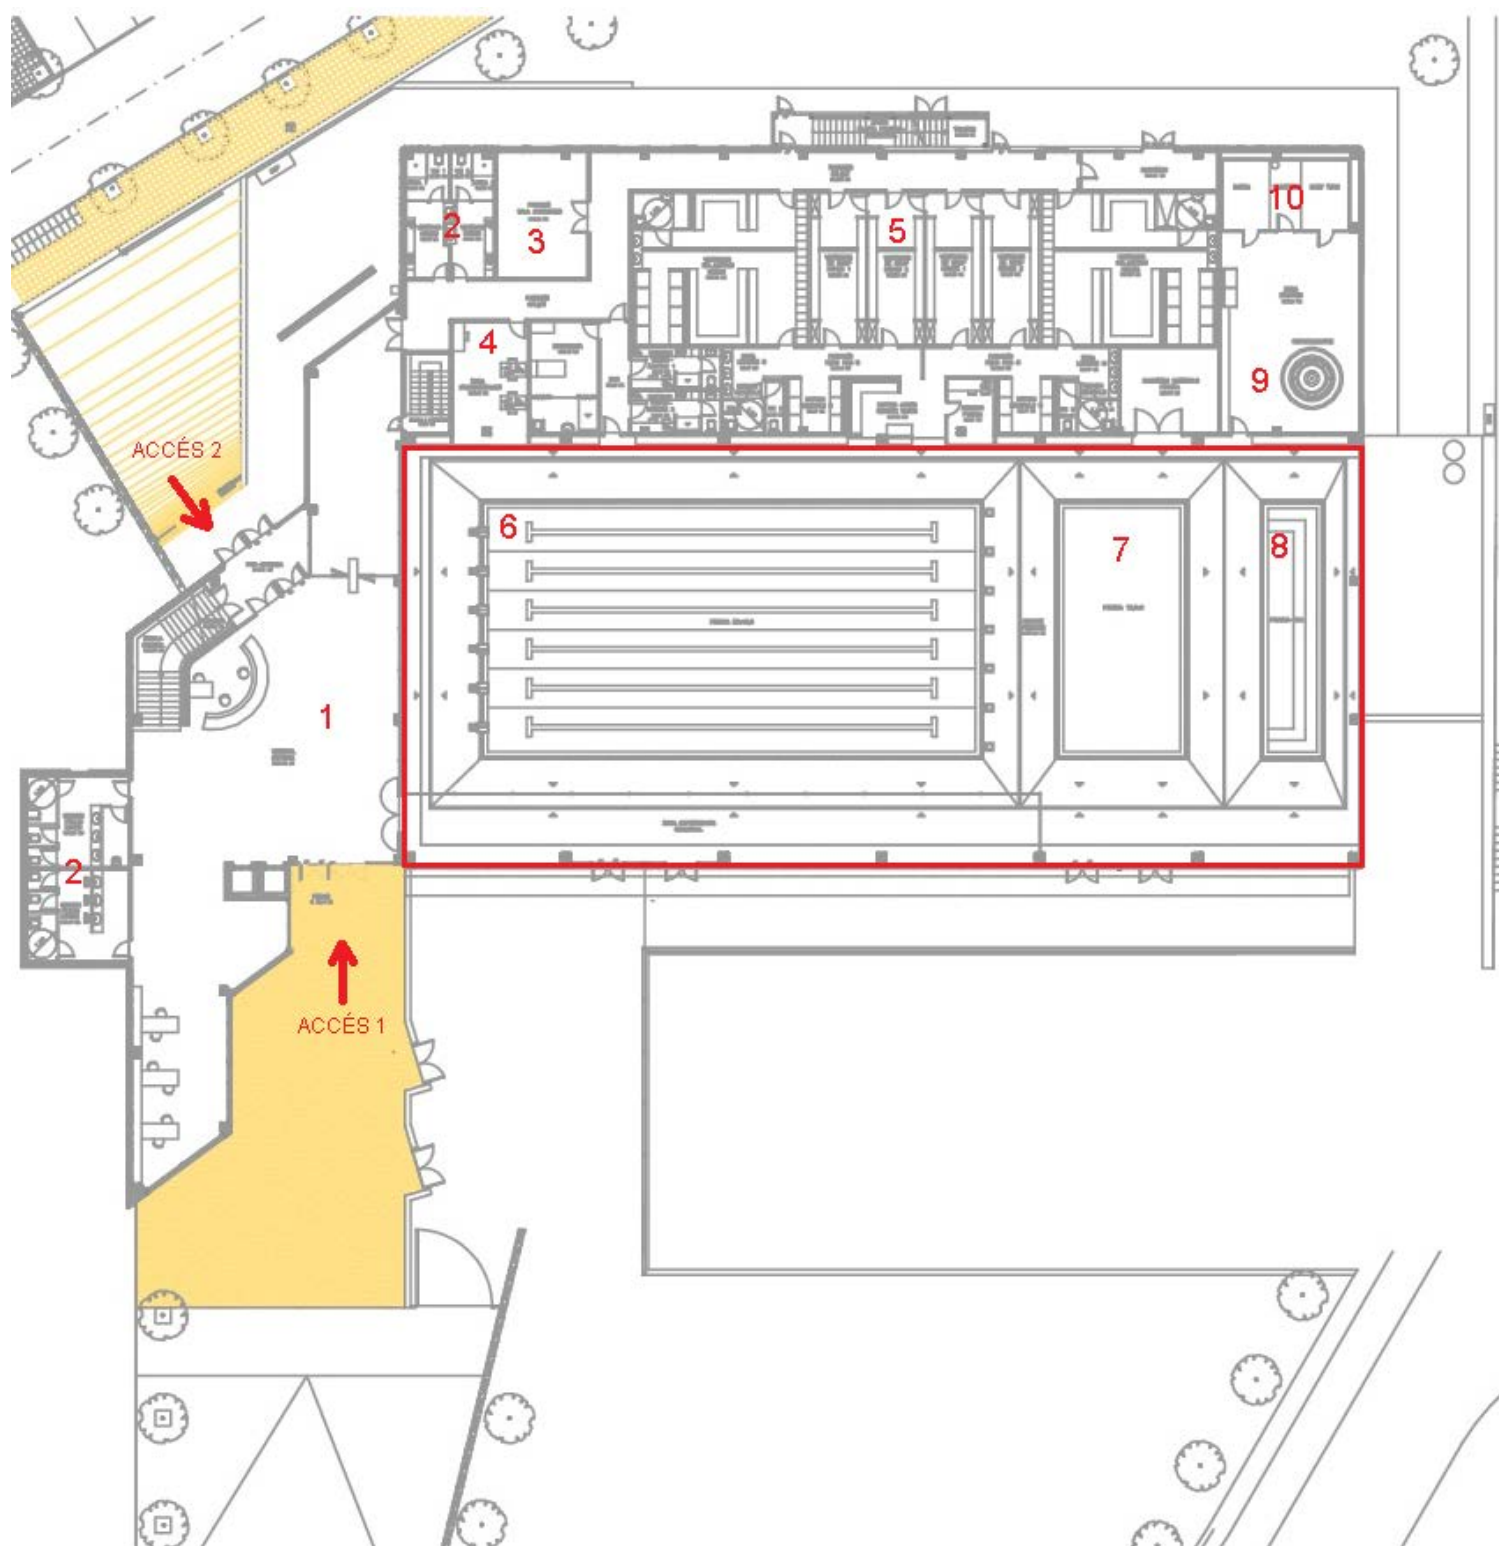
Plànol de la planta baixa, facilitat dels responsables de les instal·lacions.
